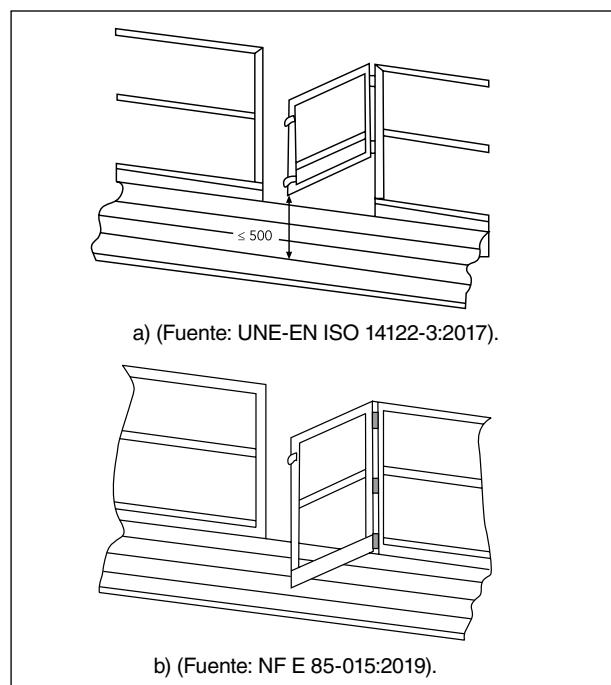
Puerta de cierre automático (abierta hacia la plataforma).⁶
